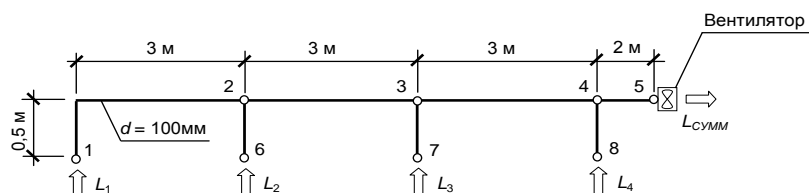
Расчетная схема системы вентиляции четырех помещений
